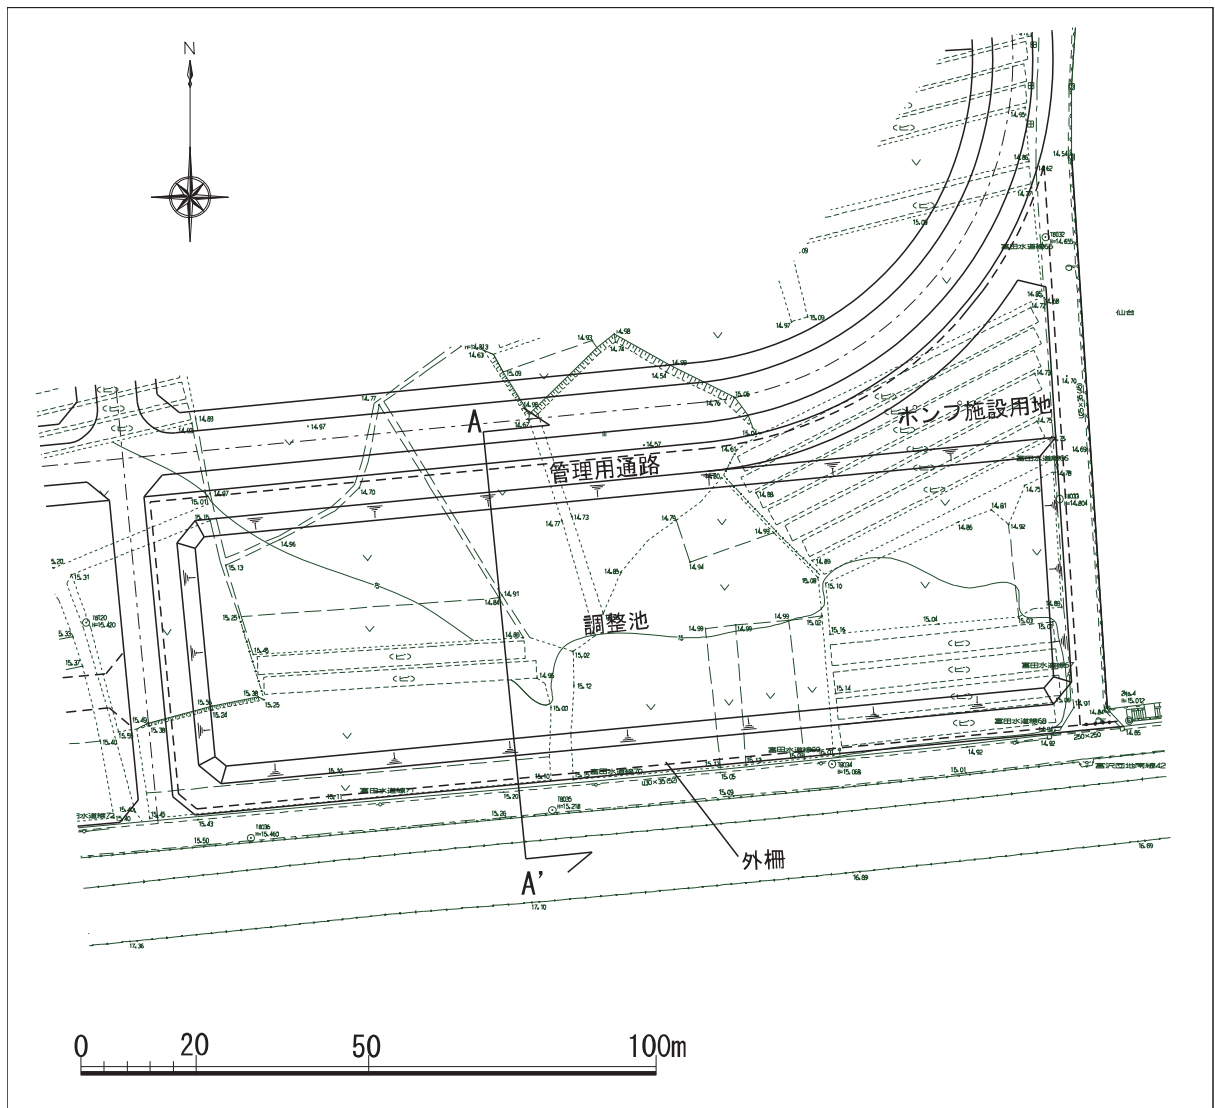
(1) 調整池計画平面図 (変更前: 評価書)
